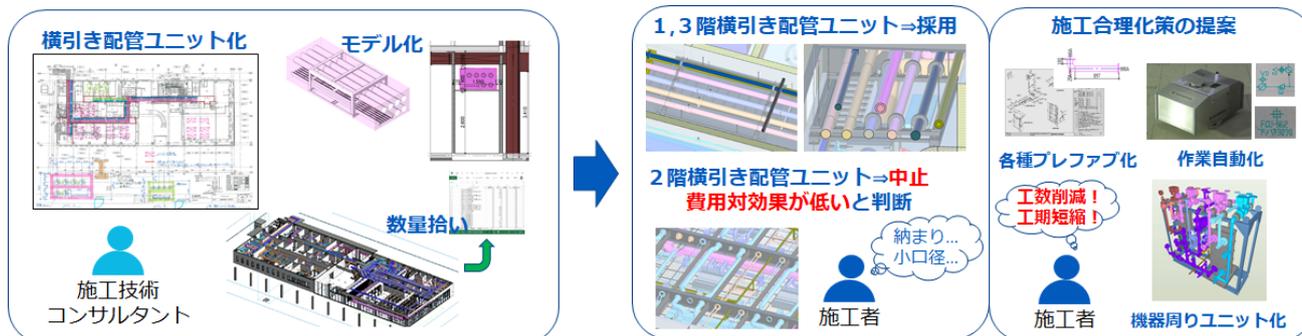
施工技術コンサルタントによる提案と施工者による施工計画
